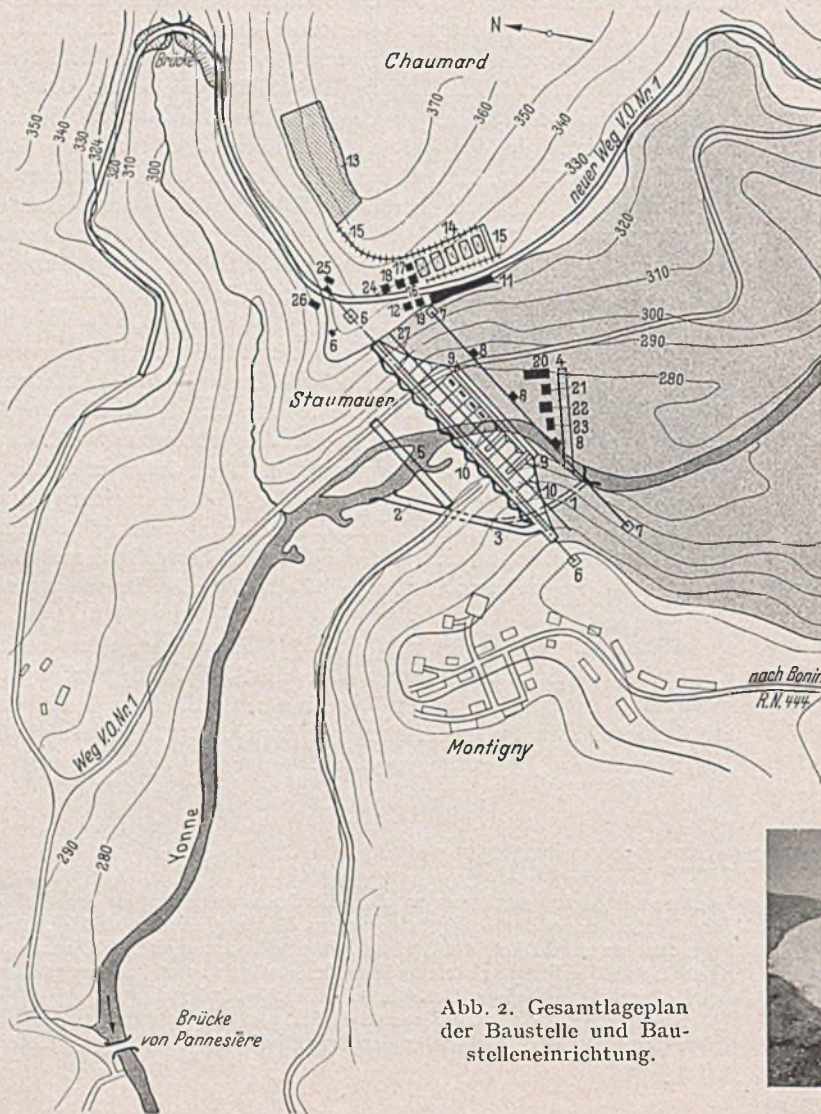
Gesamtanlageplan der Baustelle und Baustelleneinrichtung.
